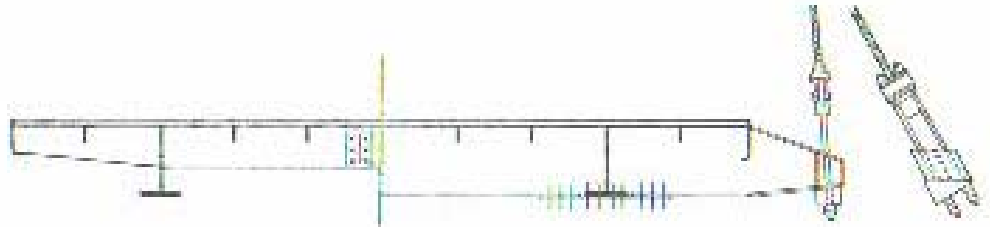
Pasarela de Raxstrasse, sección de cruce en la losa
